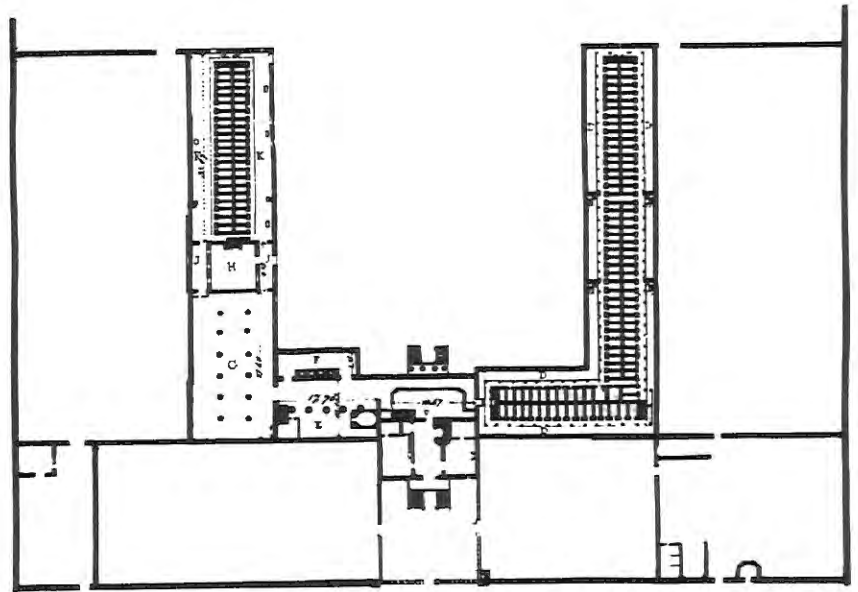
Planta do bloco de celas para a prisão de Auburn, 1825.
